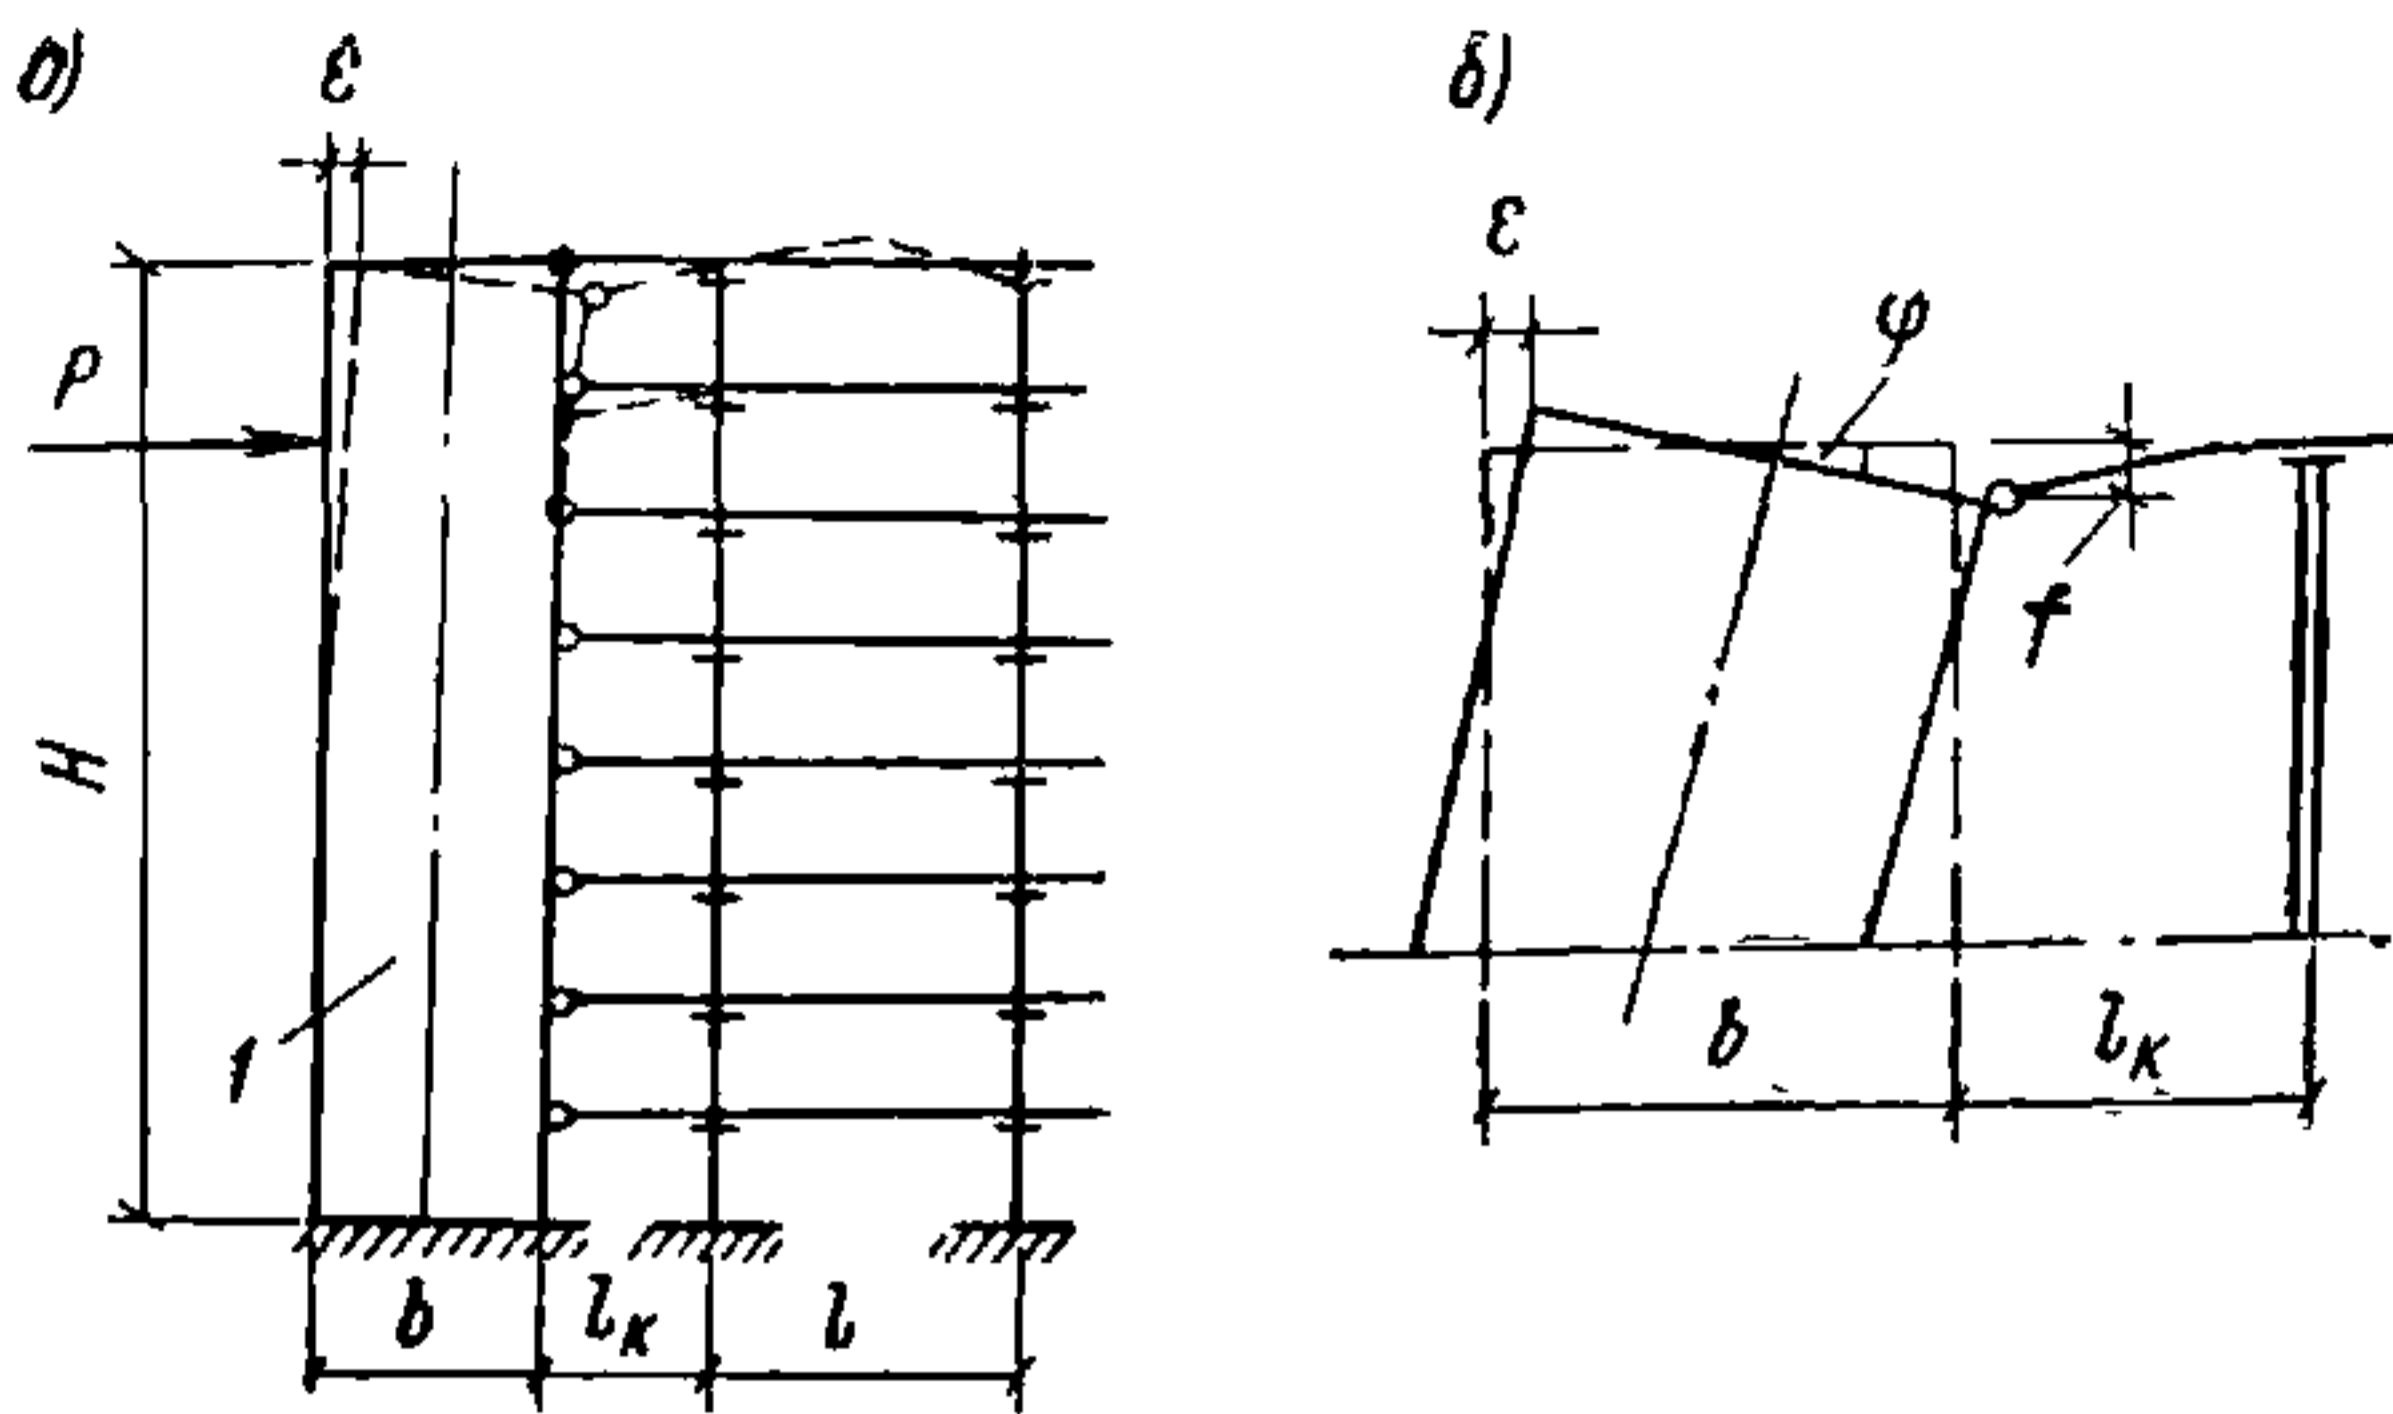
Схема определения вынужденного прогиба консолей перекрытий
